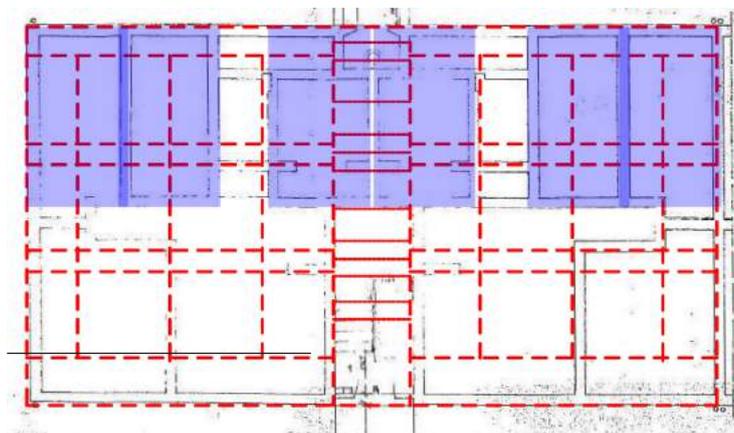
Esquema do estudo da relação entre alçados e plantas Planta Entrada
